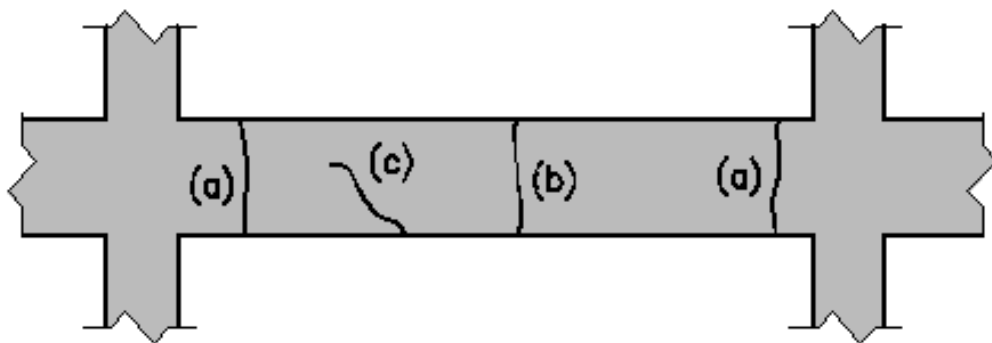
Grietas de flexión (a), (b) y corte (c) (Helene – Pereira, 2003).
